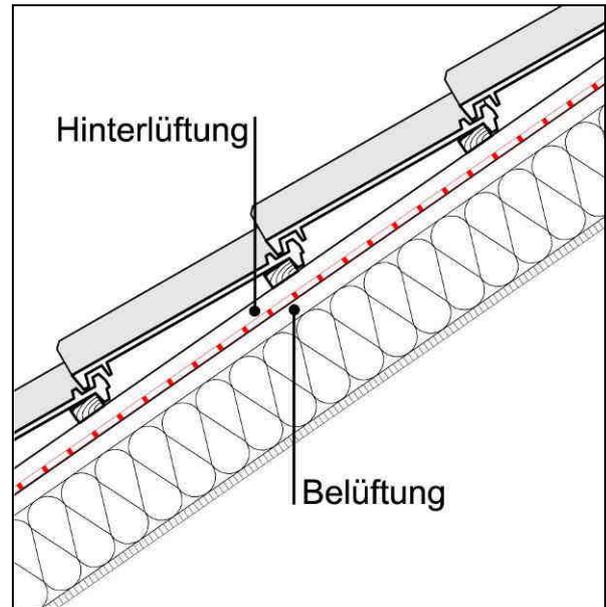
Belüftete Dachkonstruktion mit Luftspalt oberhalb der Dämmung
